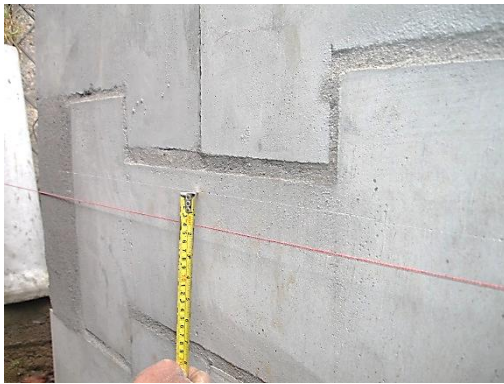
Deformación de 40mm. Mampostería propuesta.
